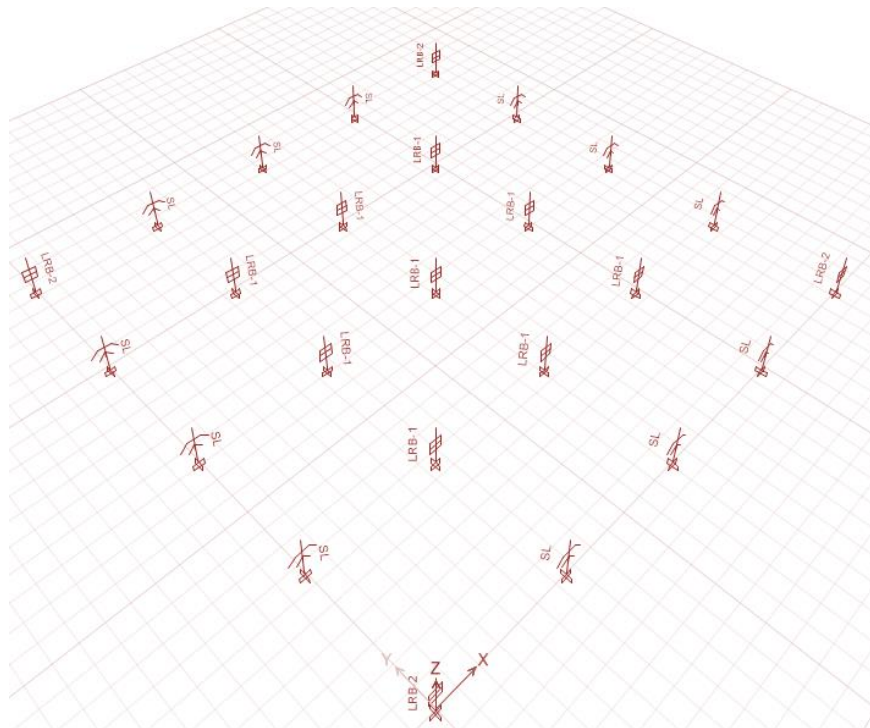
Distribución en Planta Aisladores tipo LRB y deslizador SL (Microzona Piedemonte C). Fuente: Propia.
